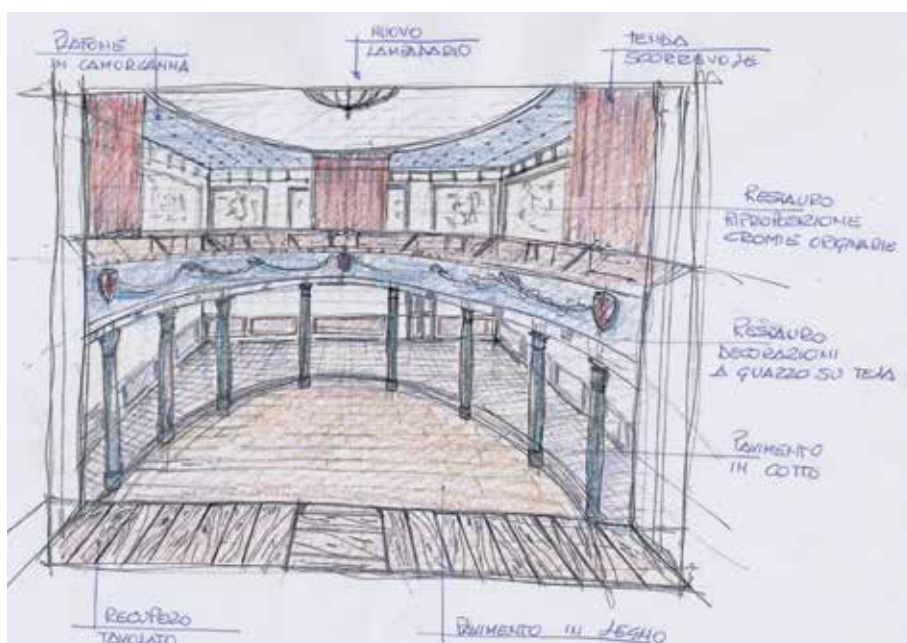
Prospetto lato sud. Vista prospettica del palcoscenico
